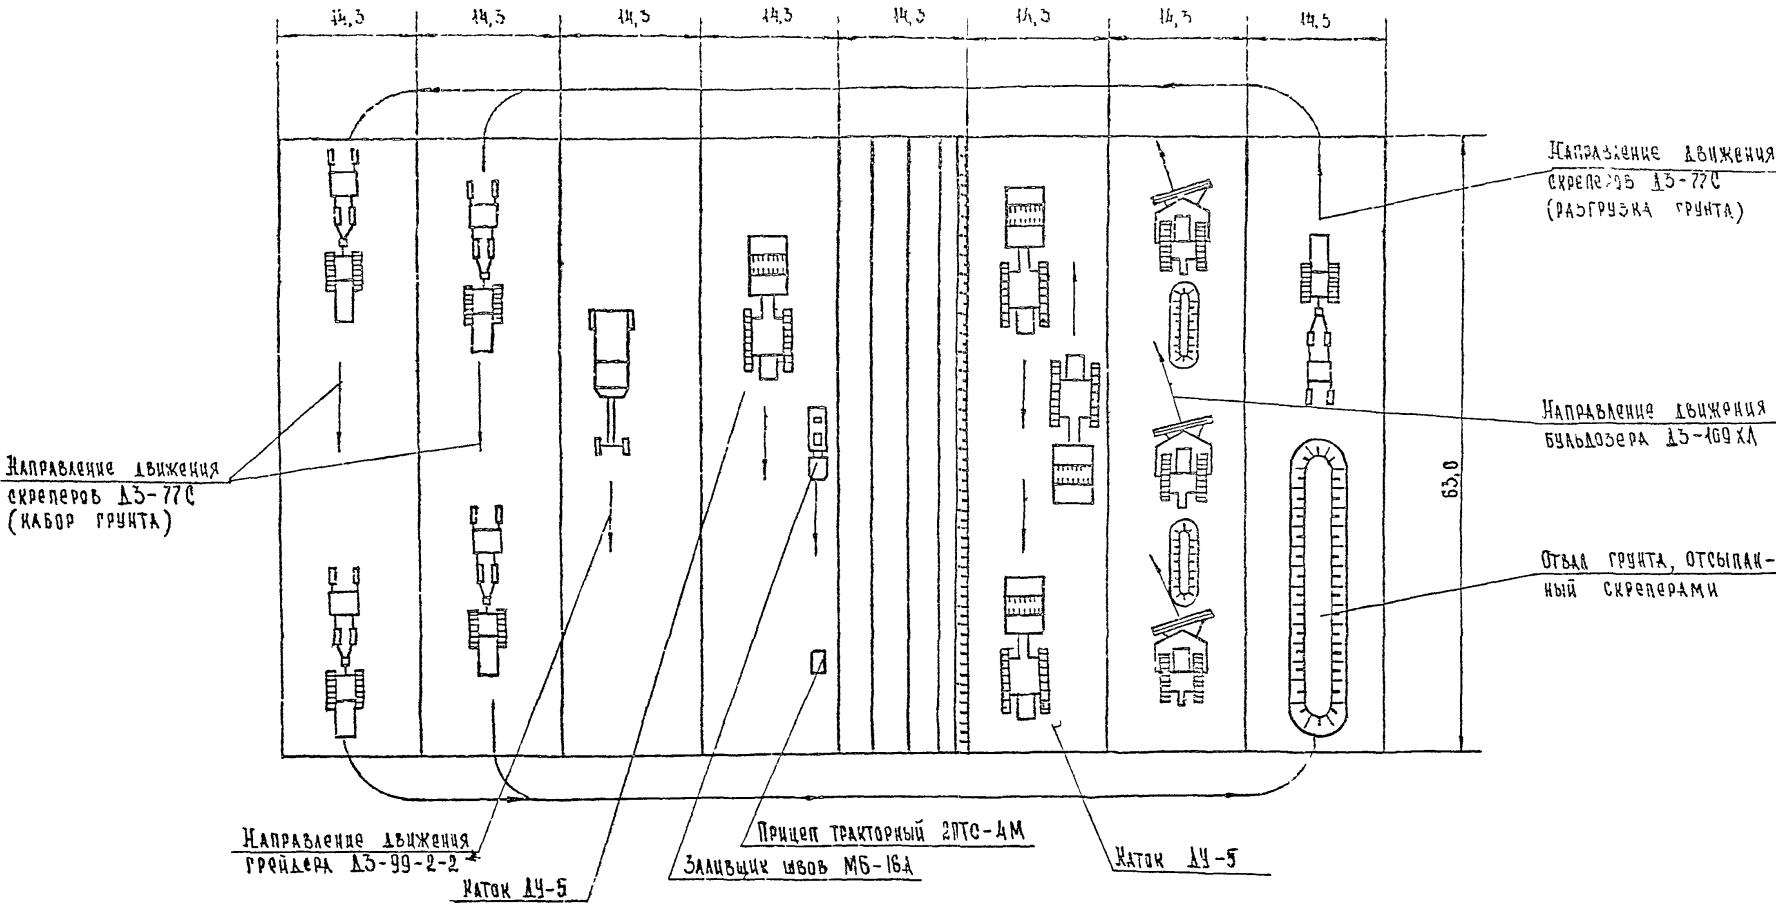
Схема производства работ по устройству грунтопахочного экрана на откосах.
